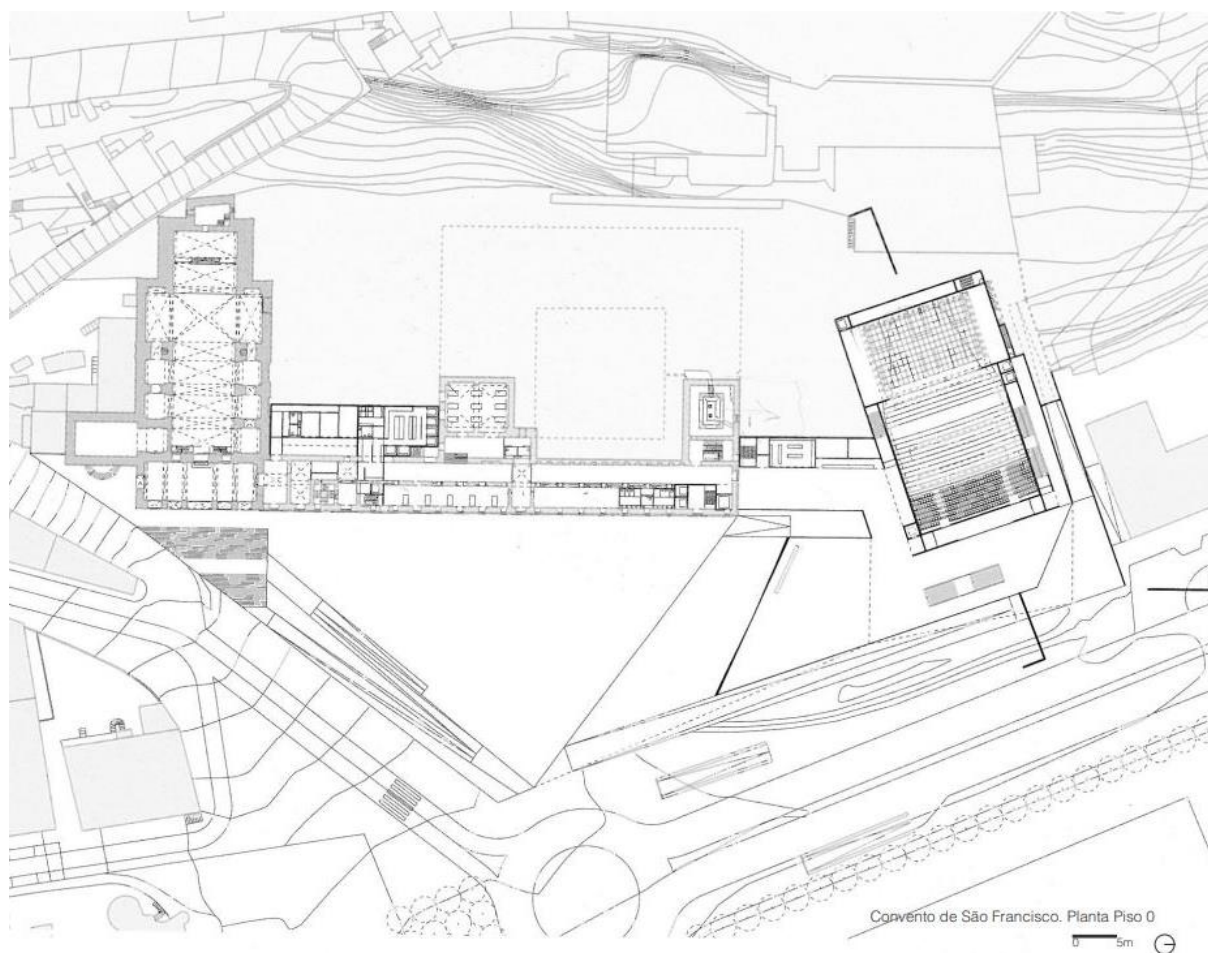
Planta do projeto inicial de reabilitação do Convento de São Francisco (Coimbra), da autoria do arquiteto Carrilho da Graça.
